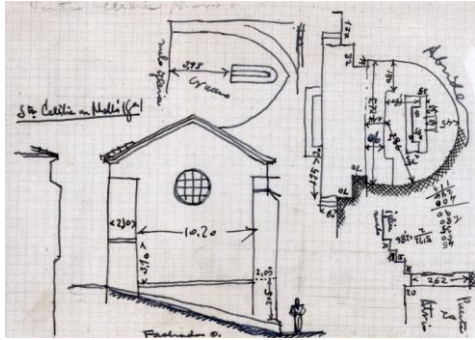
Molló. Iglesia de Santa Cecilia AAFV. Croquis alzado Oeste
